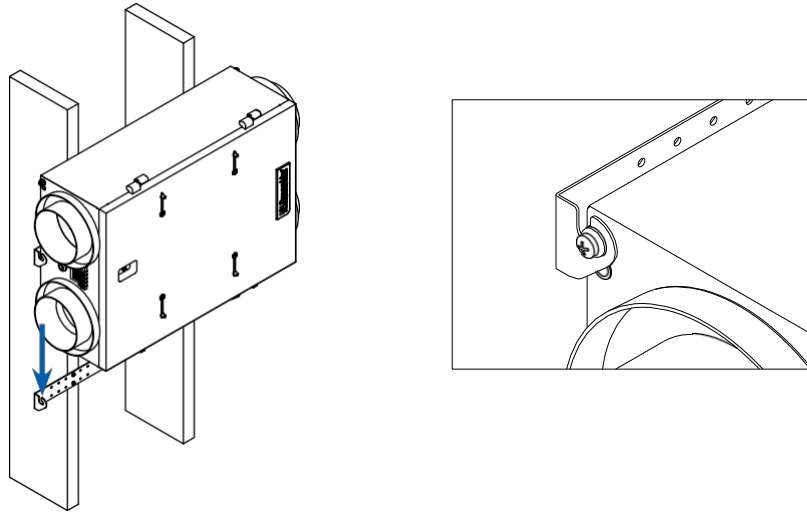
INSTALLATION VERTICALE SUR UN MUR OU UN PANNEAU (SUITE)
